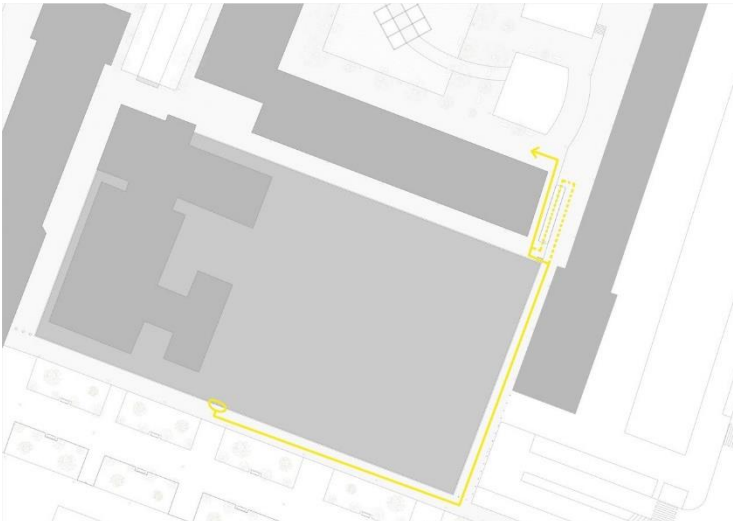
Recorrido 4 puerta calle Campoamor.
